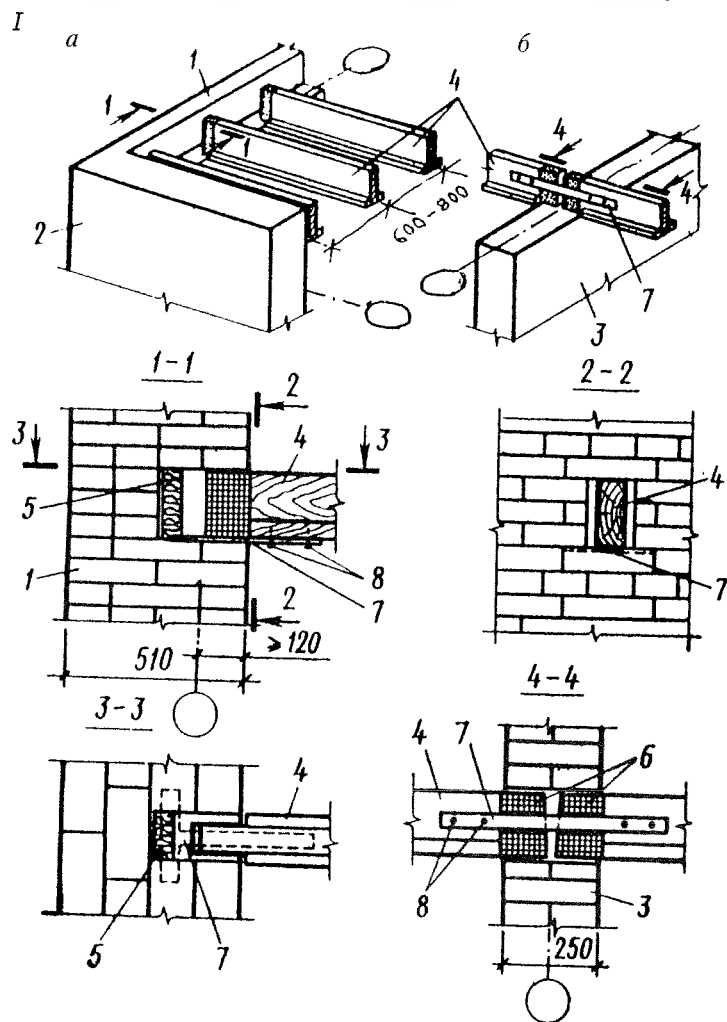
Опирание балок перекрытий на каменные стены:
